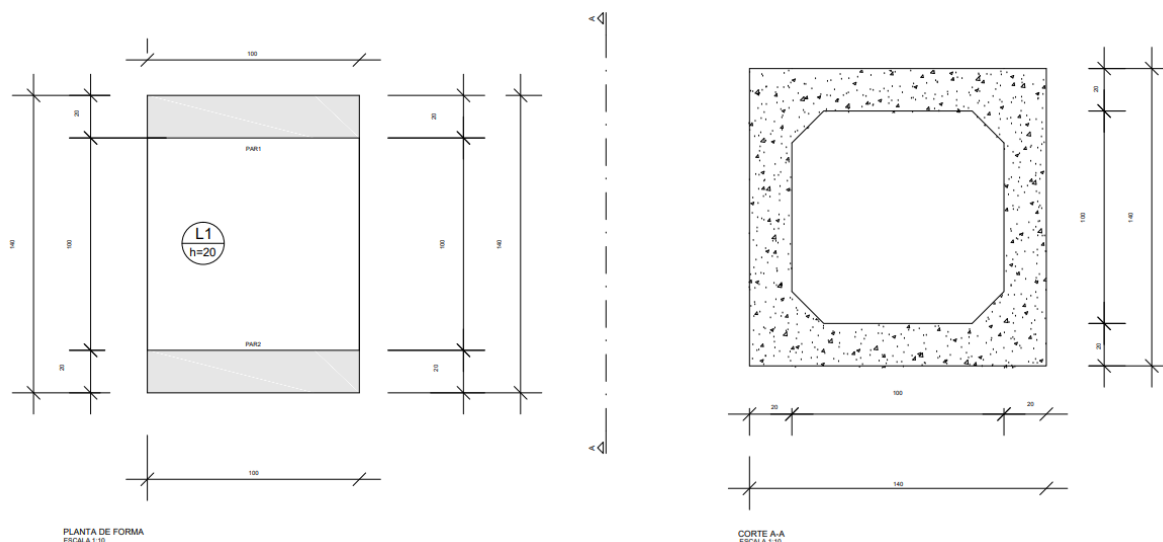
Galeria – corte e planta seção 1,00 m x 1,00 m.
